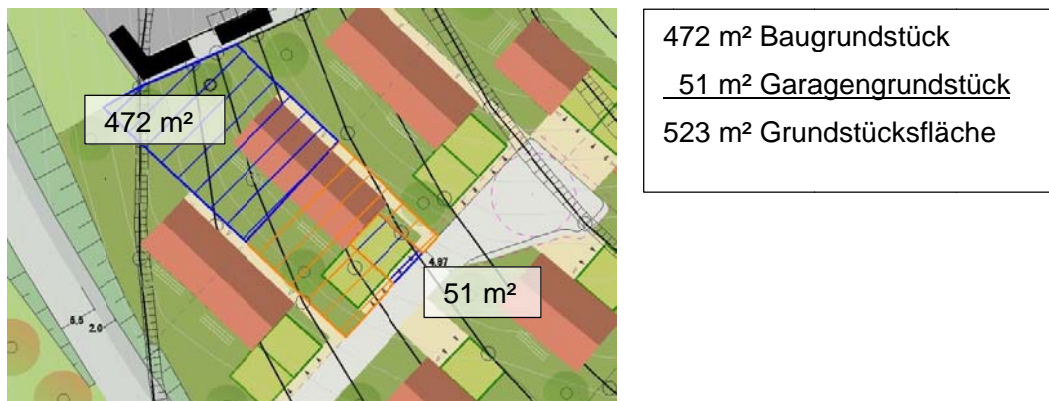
Städtebaulicher Entwurf – Ausschnitt
